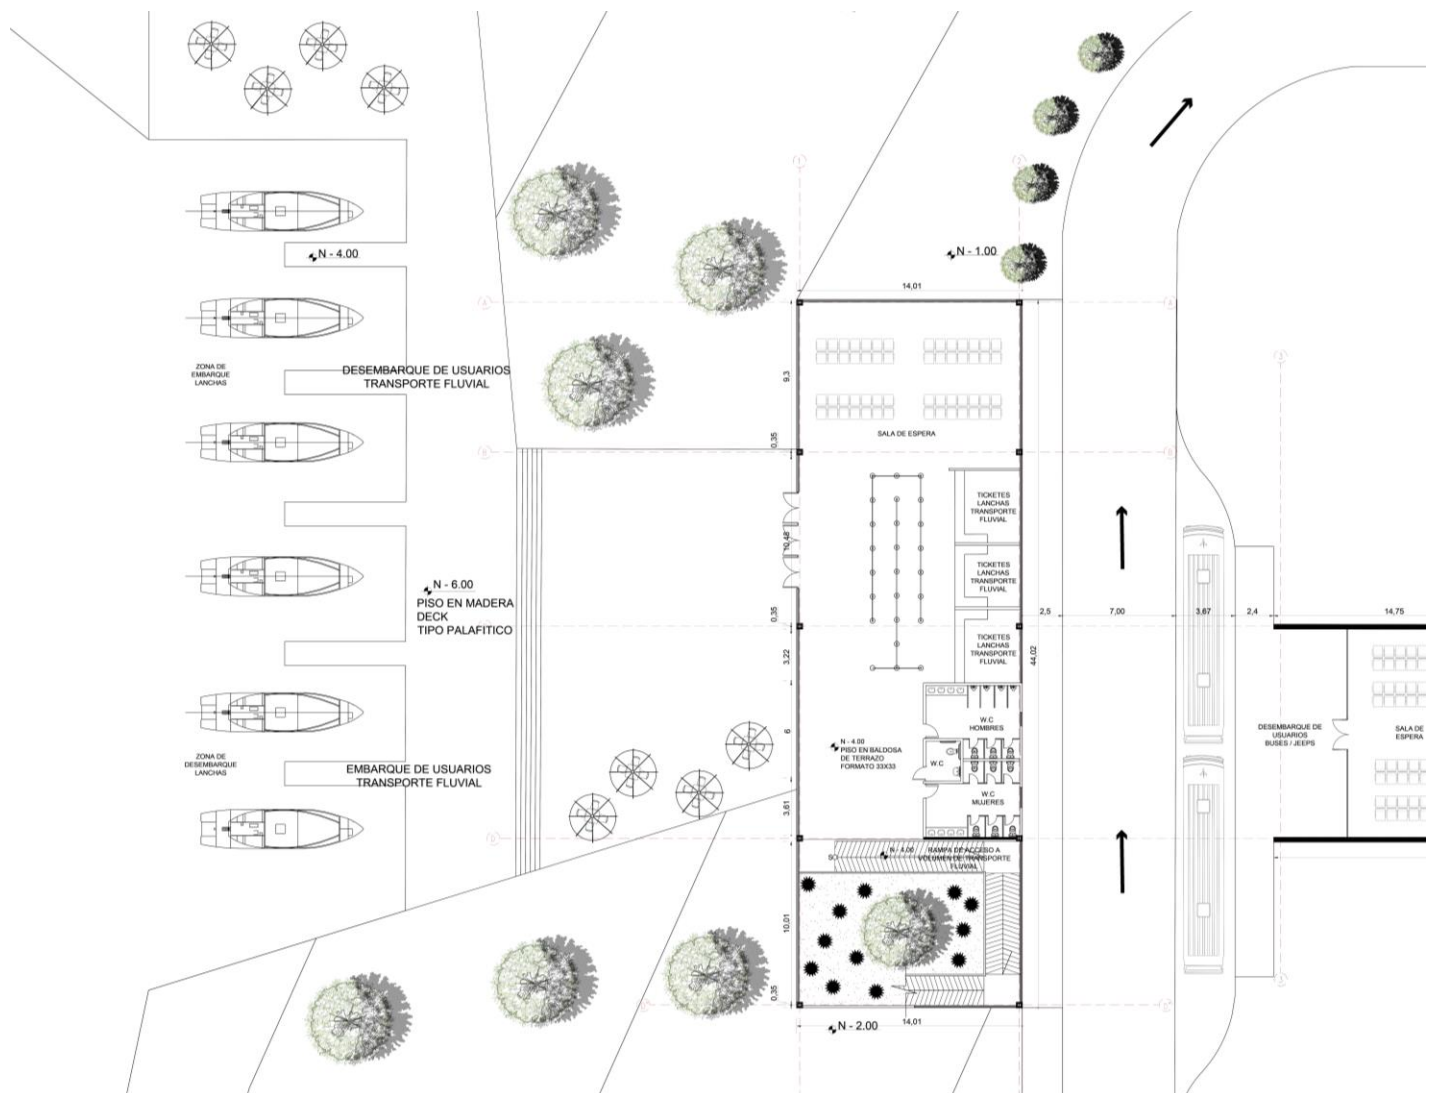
Planimetría amoblada nivel 0.00 parte 3.
